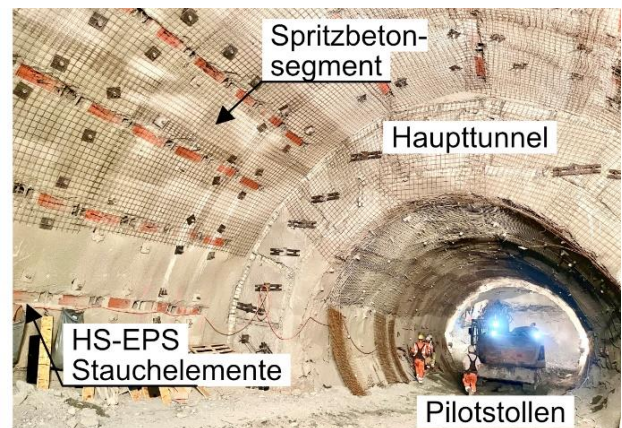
Übersicht der duktilen Spritzbetonschale mit HS-EPS Stauchelementen im vorseilenden Pilotstollen und nachlaufendem Haupttunnel [4].
